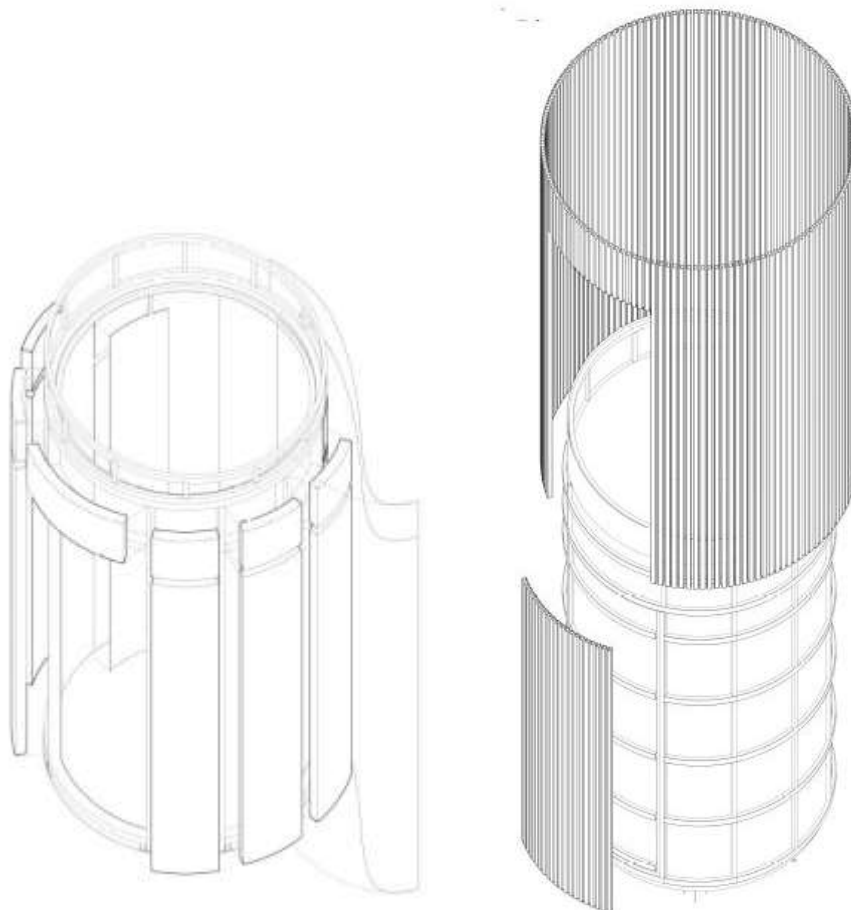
Sistema de fachada. Capas interiores y recubrimiento exterior de la fachada ventilada
